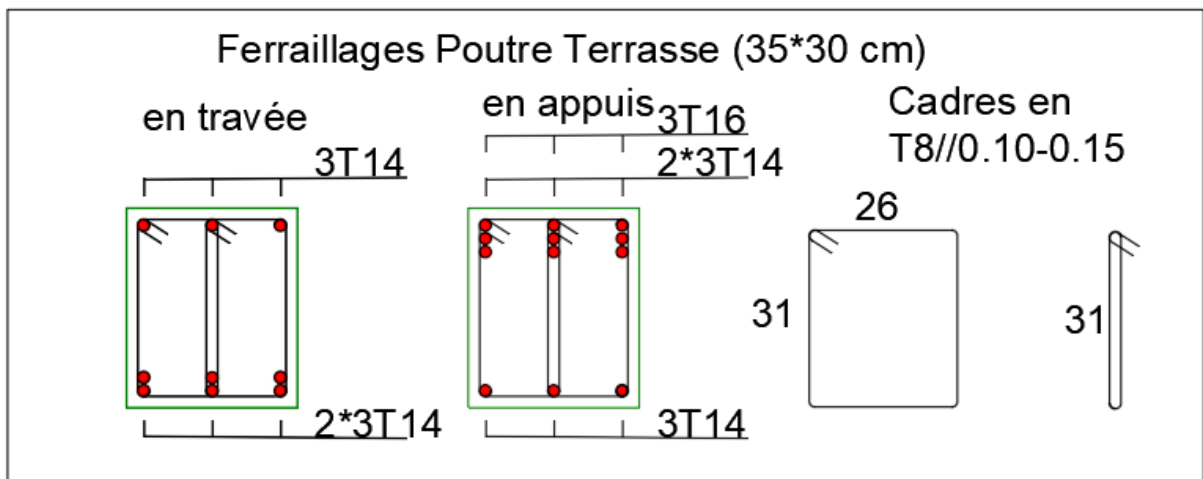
Ferraillages Poutre Terrasse 35\*30 cm.
